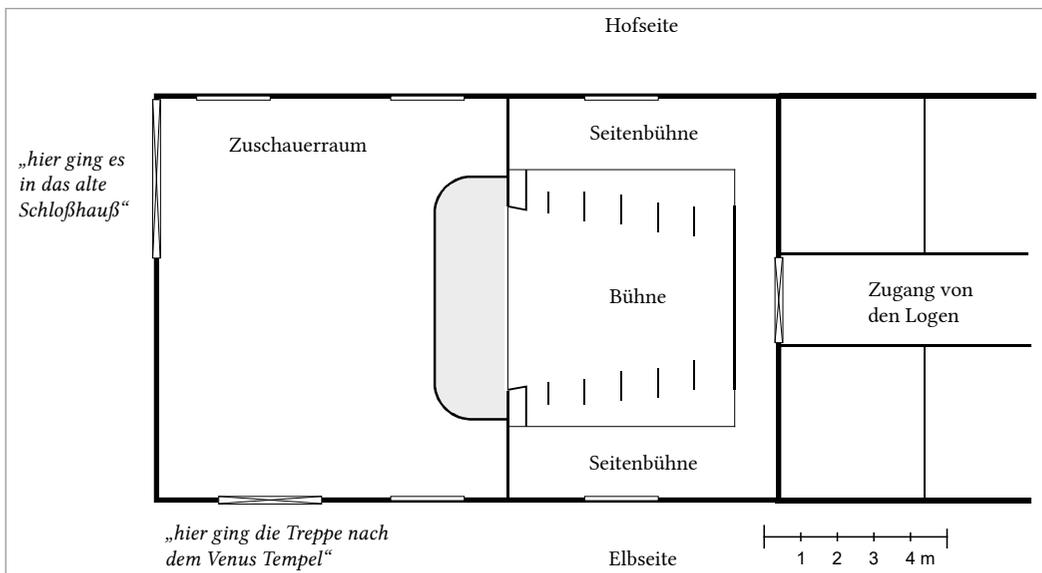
Logenhaus im alten Pillnitzer Schloss, Rekonstruktionsversuch des Grundrisses (Zeichnung des Verfassers).
